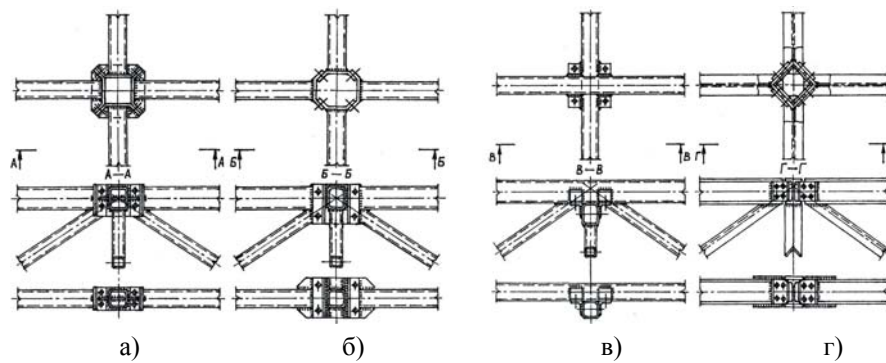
Схемы узлов пересечения стальных перекрестных ферм в виде монтажных стыков: а – на гнутых фланцах с диафрагмами жесткости; б – на гнутых фланцах без элементов жесткости; в – с поэтажным расположением пересекающихся поясов; г – на уголковых фасонках с листовыми накладками
